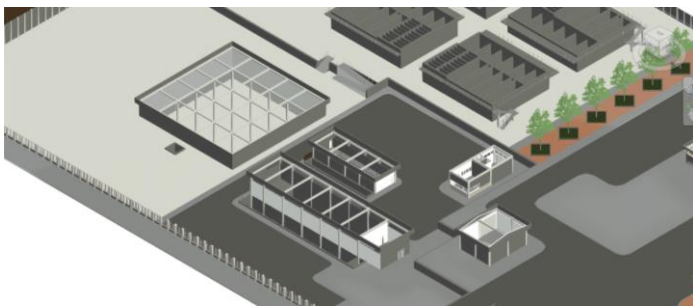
Paredes Y Estructuras Modelado BIM 3D
